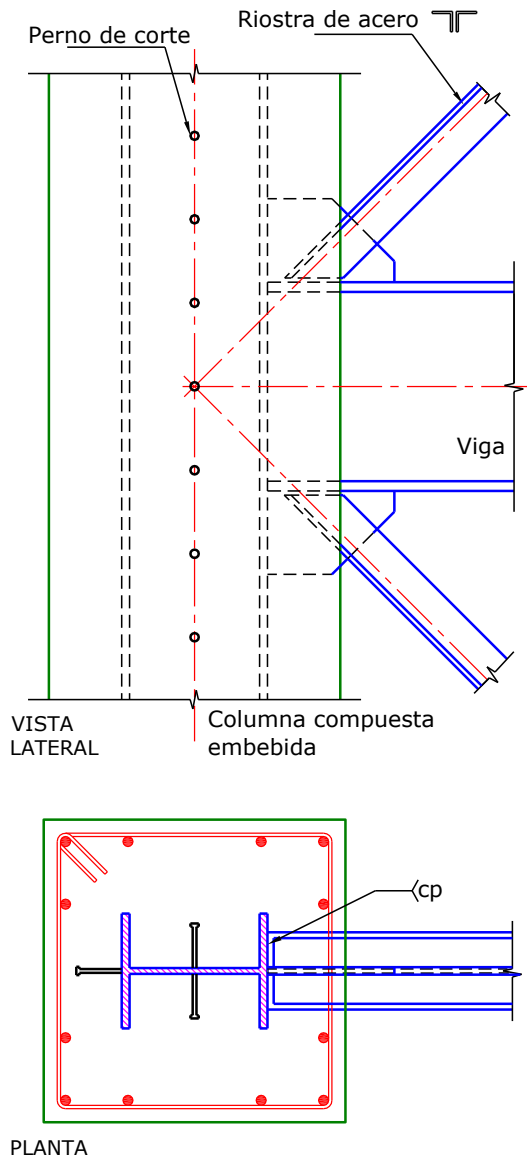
Conexión compuesta para las riostras y viga de un pórtico arriostrado.
